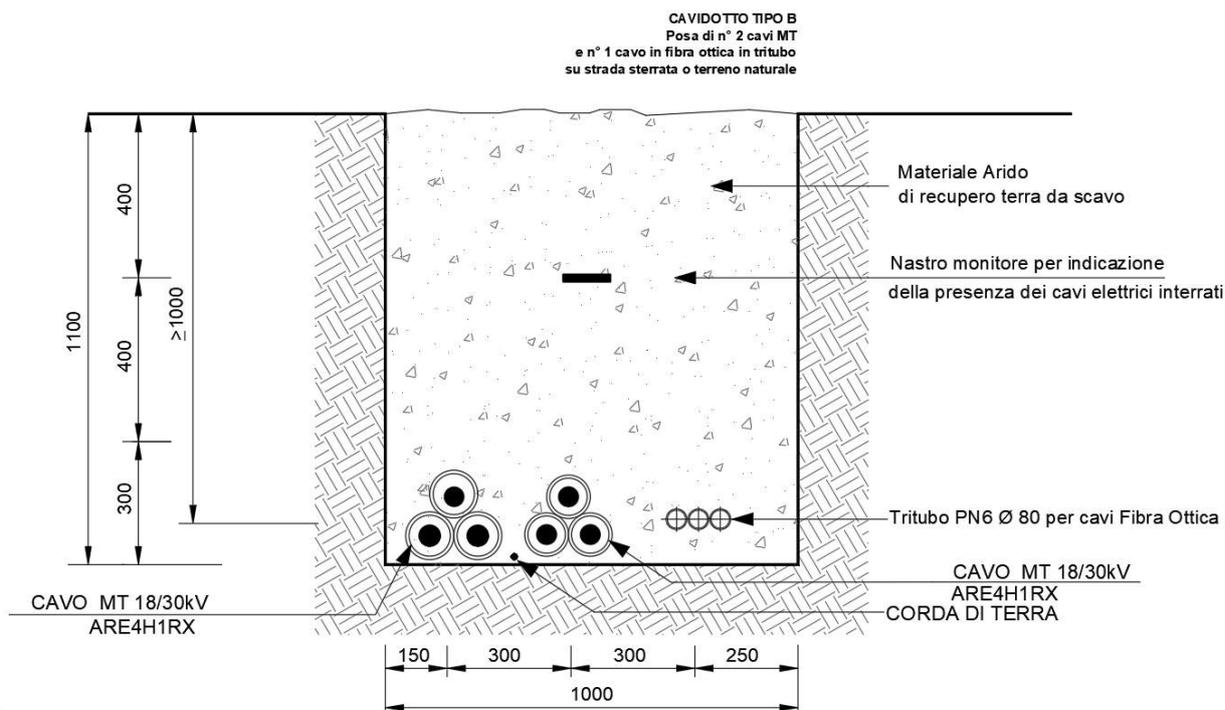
Sezione tipo posa cavi MT a 30 kV
